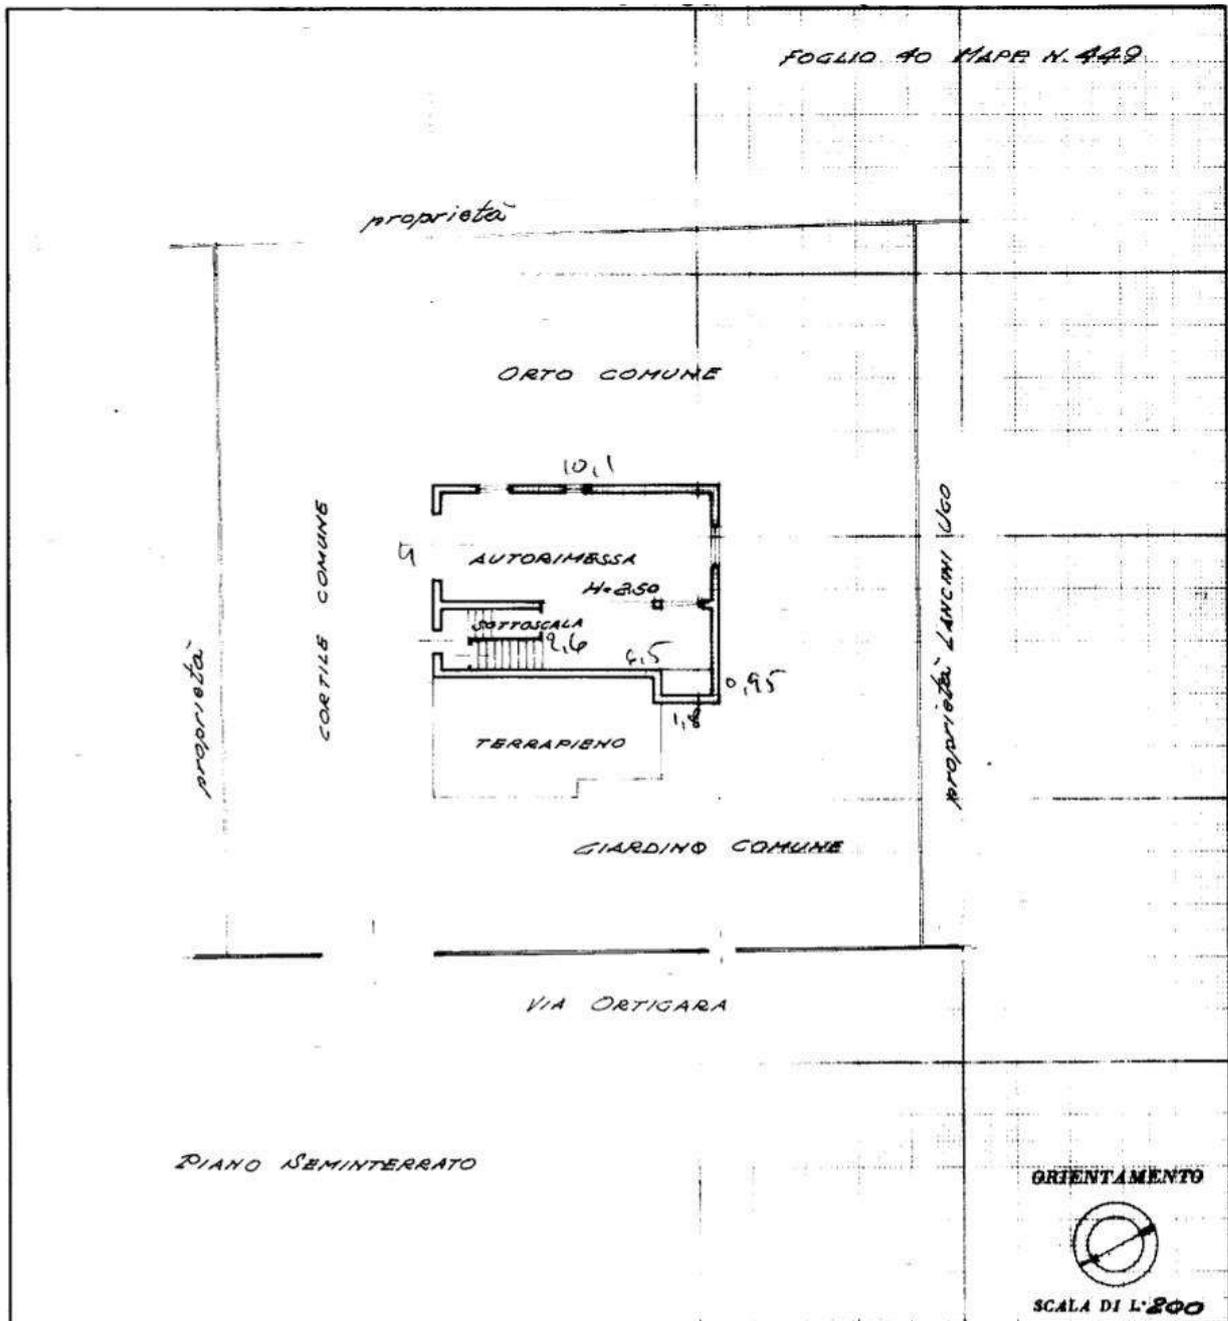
Estratto planimetria catastale Part. 449 sub. 3
